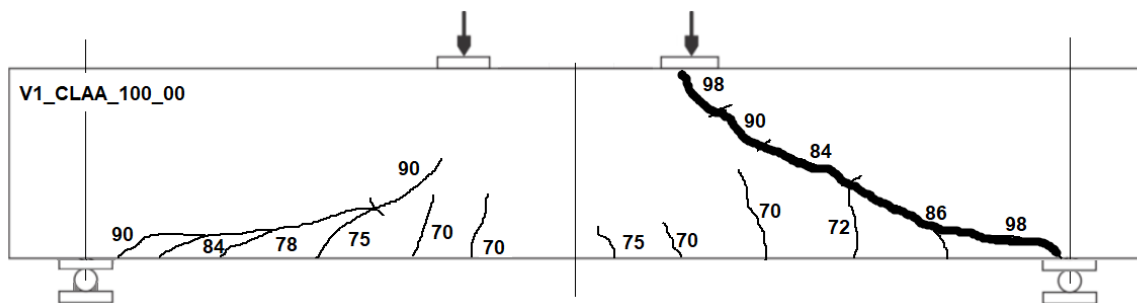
Esquema de fissuração da Viga 1_CLAA_100_00.
